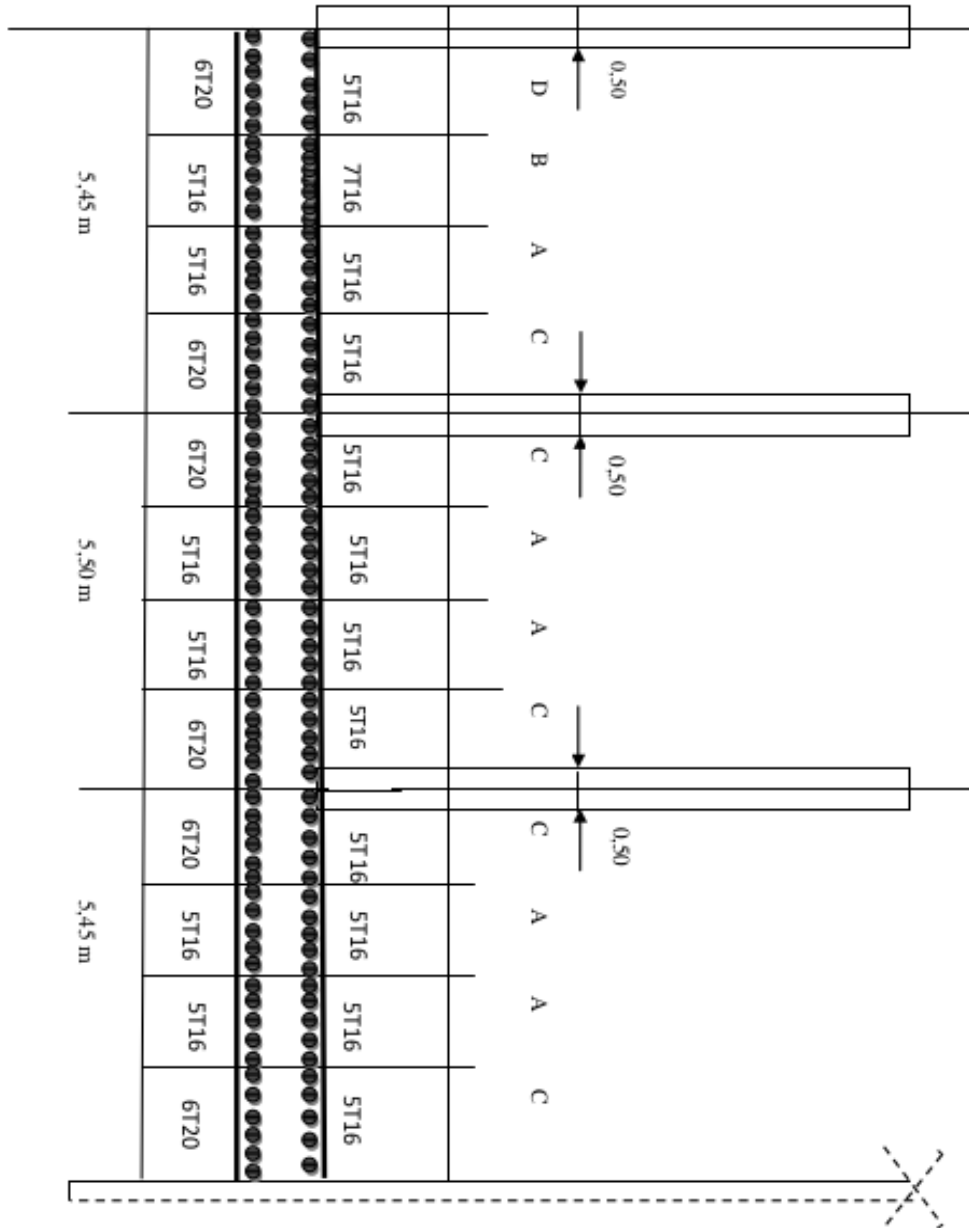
Schéma de ferrailage du radier suivant X-X(appui-travée).
